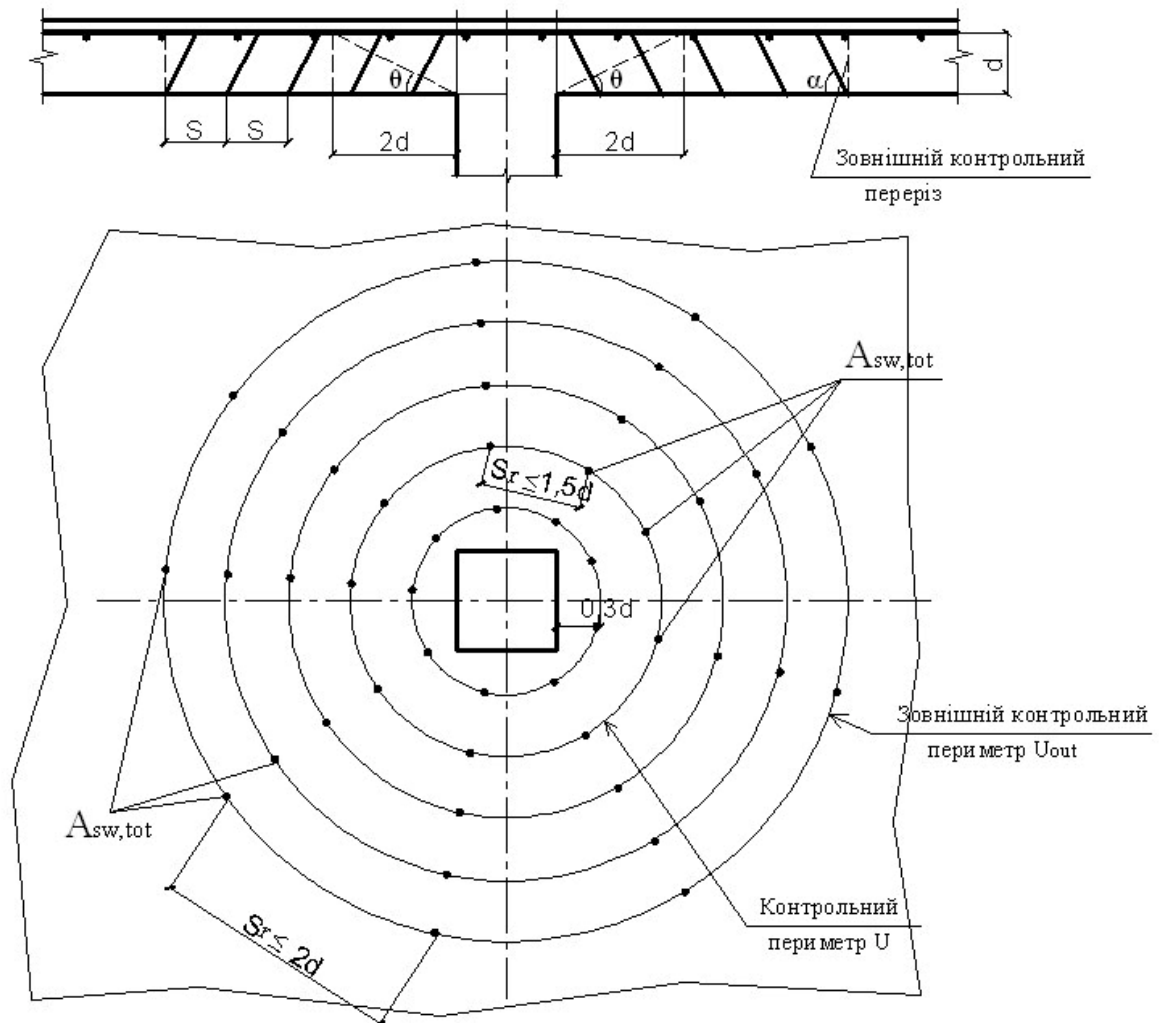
Поперечне армування плити перекриття проти продавлювання
